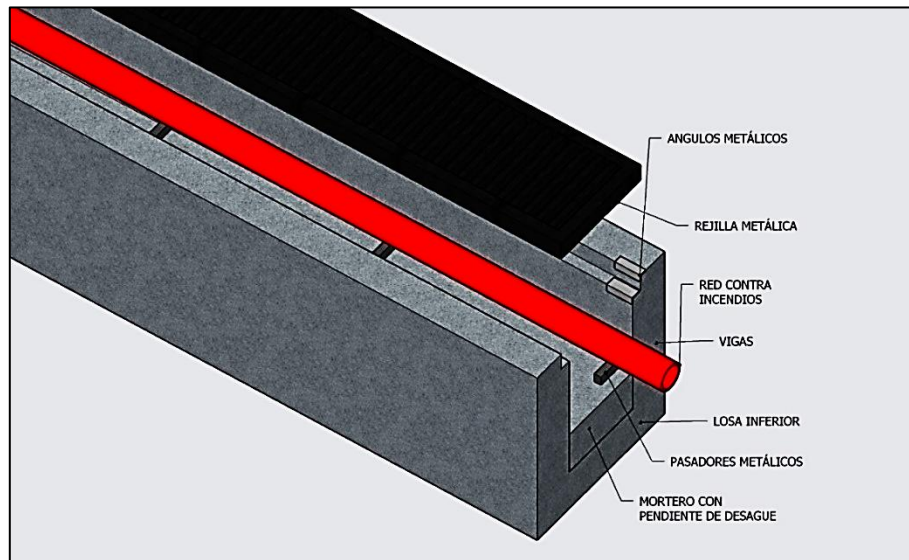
Detalles constructivos y elementos de cárcamo. Fuente: elaboración propia.
